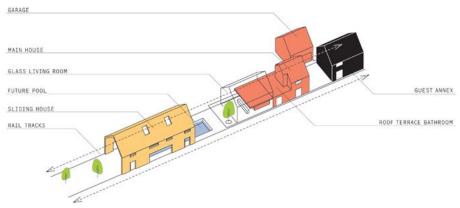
Sliding house. (Fuente: http://drmm.co.uk)
